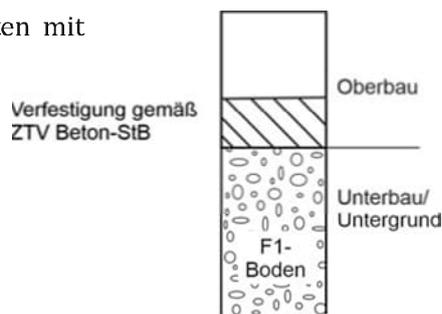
Bauweisen auf F1-Böden mit Verfestigung gemäß ZTV Beton-StB
